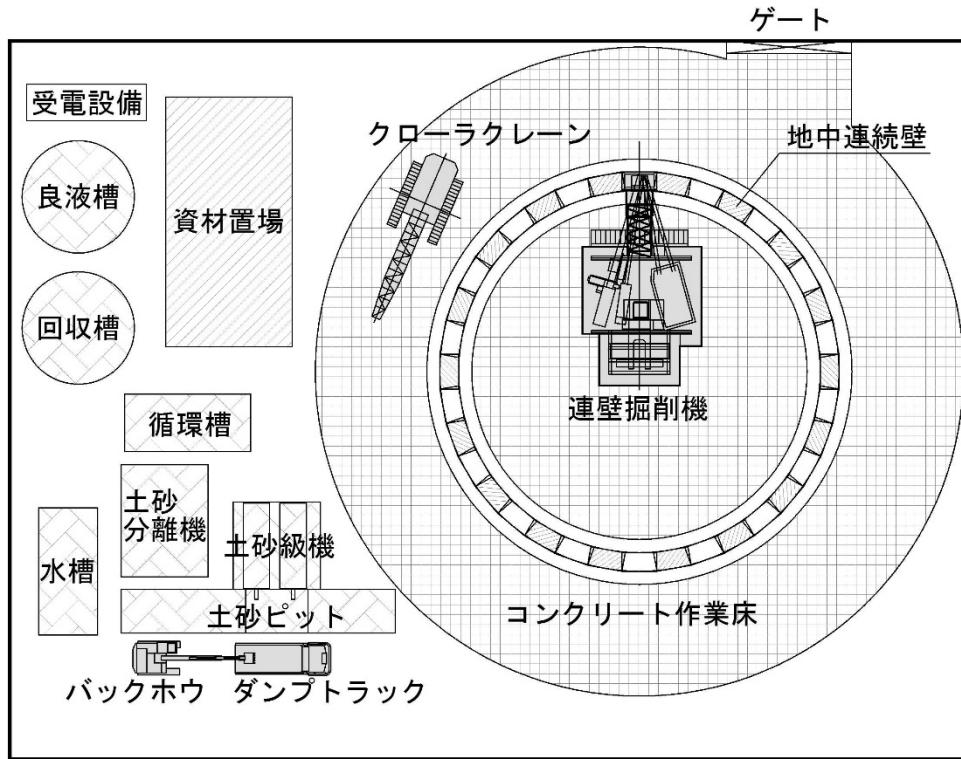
非常口の施工ヤードの概要 (RC 地中連続壁工法による非常口施工時)
